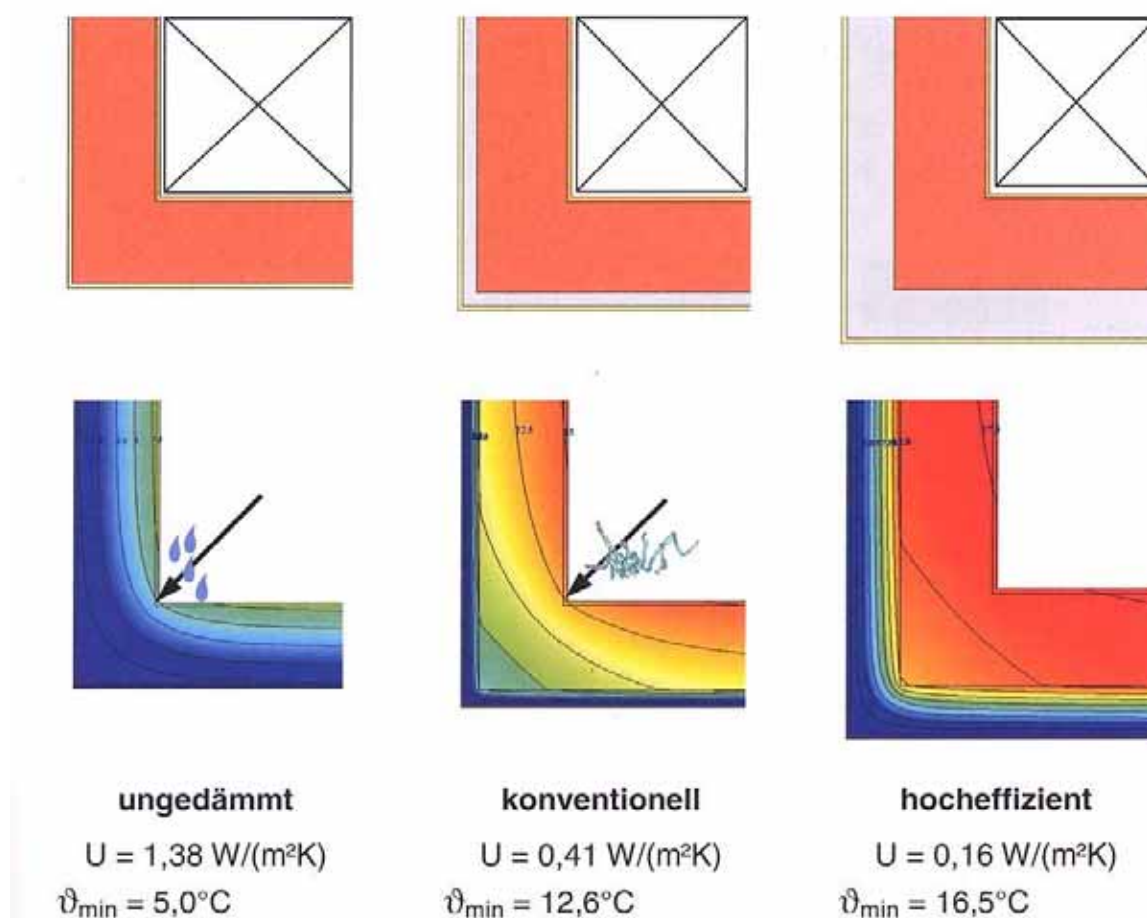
Detailanschluss Außenwandkante (Vollziegel) – mit Schrank
